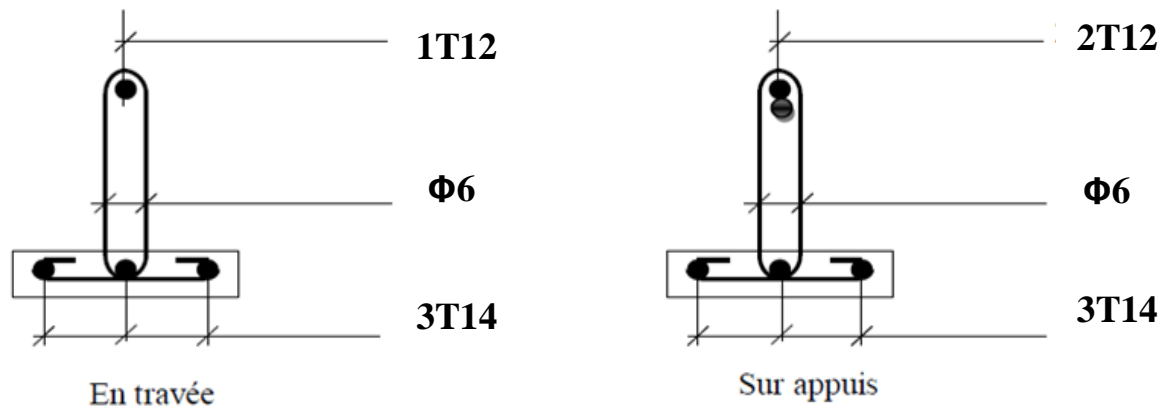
Disposition constructive de ferrailage de poutrelle en travée et sur appui.
